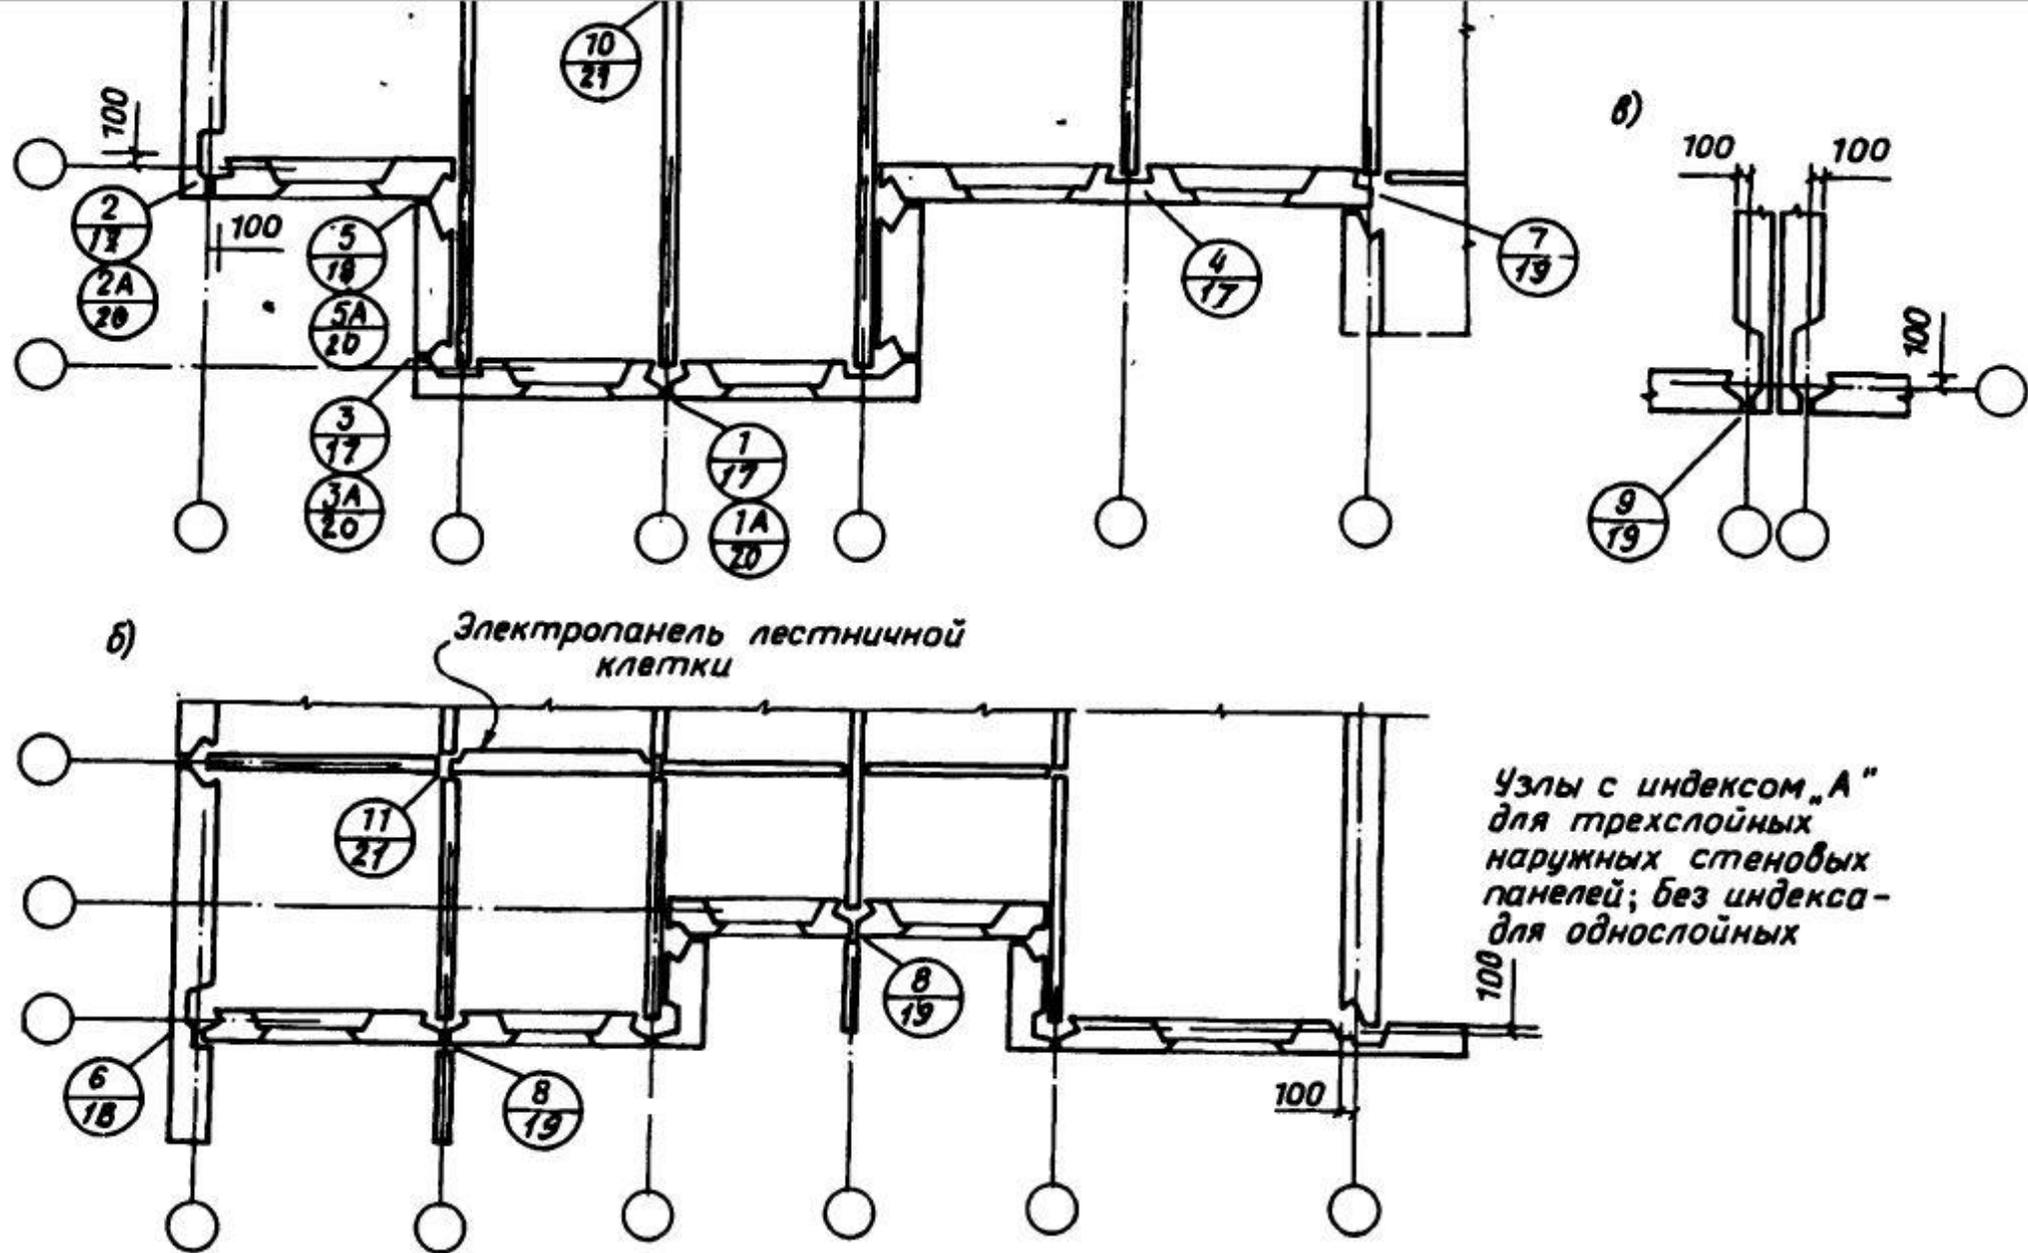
Крупнопанельные 5 - 9-этажные здания с малым шагом несущих поперечных стен, фрагменты монтажных планов установки стеновых панелей: а, б - варианты сопряжений панелей наружных и внутренних стен; в - температурно - деформационный шов здания
